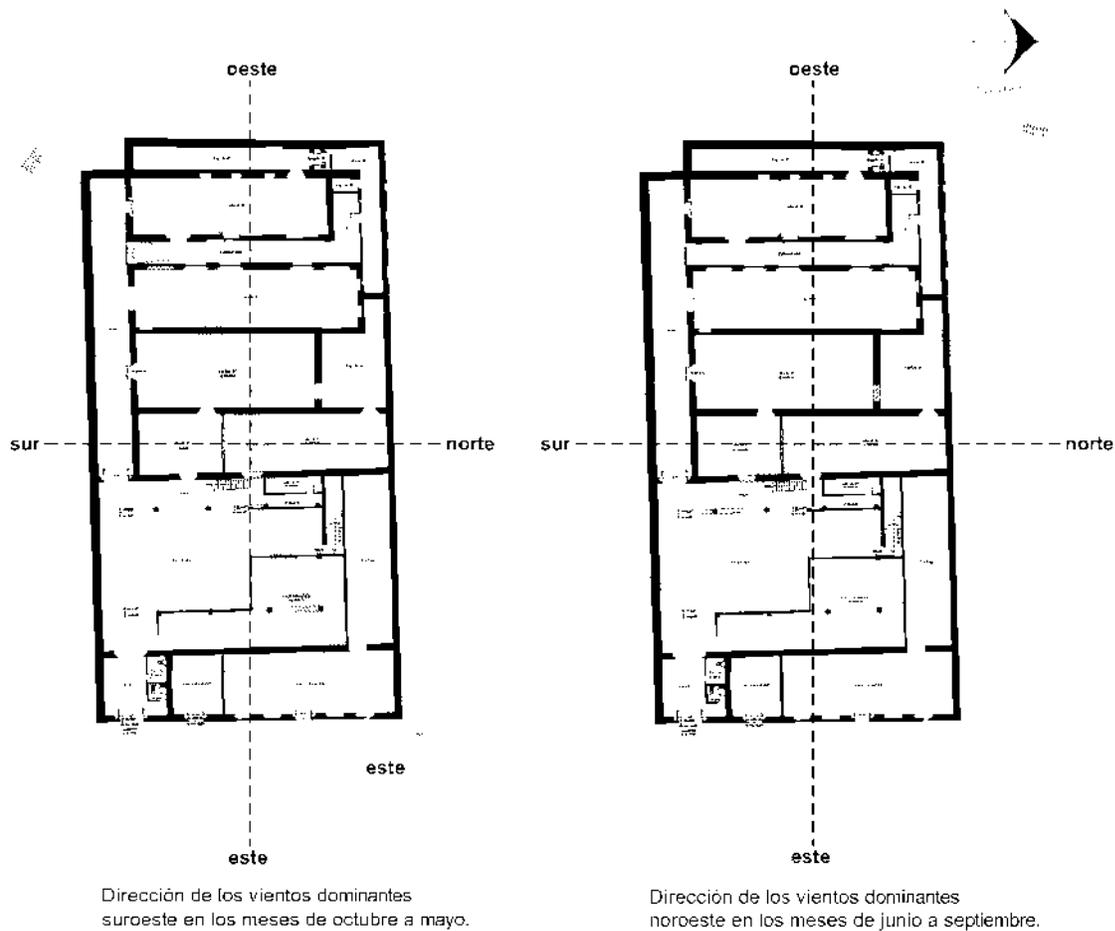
Planta de ventilación del inmueble. Fuente: Elaboración propia.
